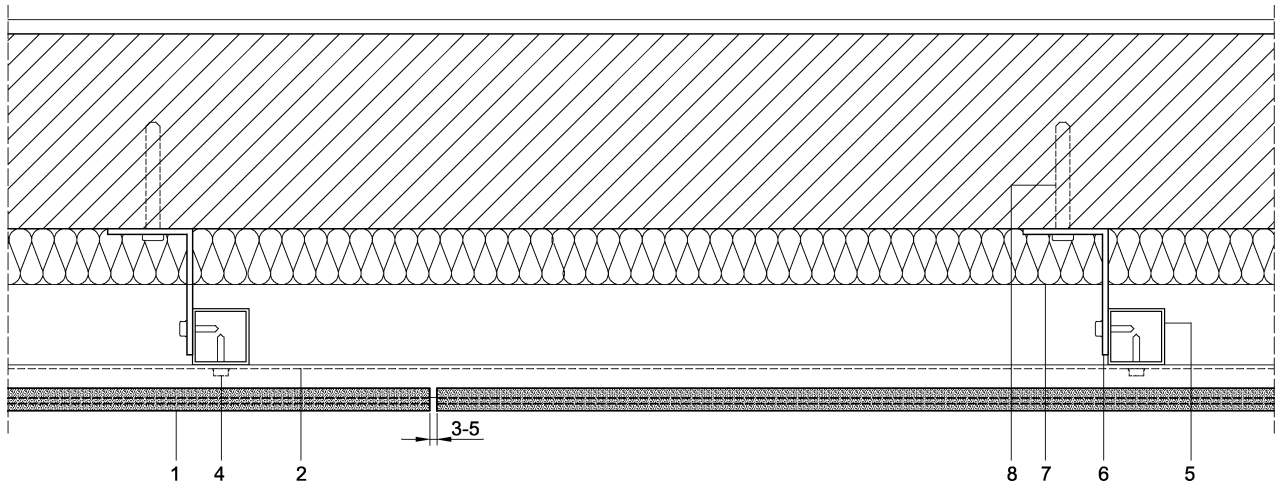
Sección horizontal de la fachada Faveton® Bersal.
